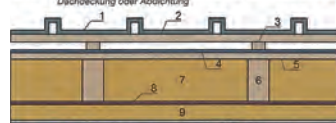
Nachweisfreie Dächer mit Gefächdämmung und Holzschalung – Luftdichtheitsschicht unterhalb des Sparrens (auch für helle Dachoberflächen)
